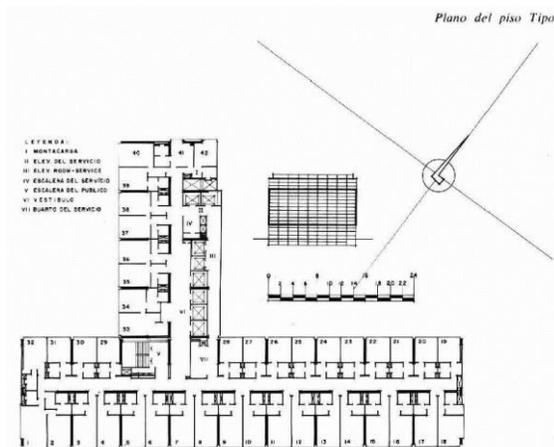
Planta del piso tipo, Hotel María Isabel. Fuente: Revista Arquitectura México, No. 78, junio, 1962.
